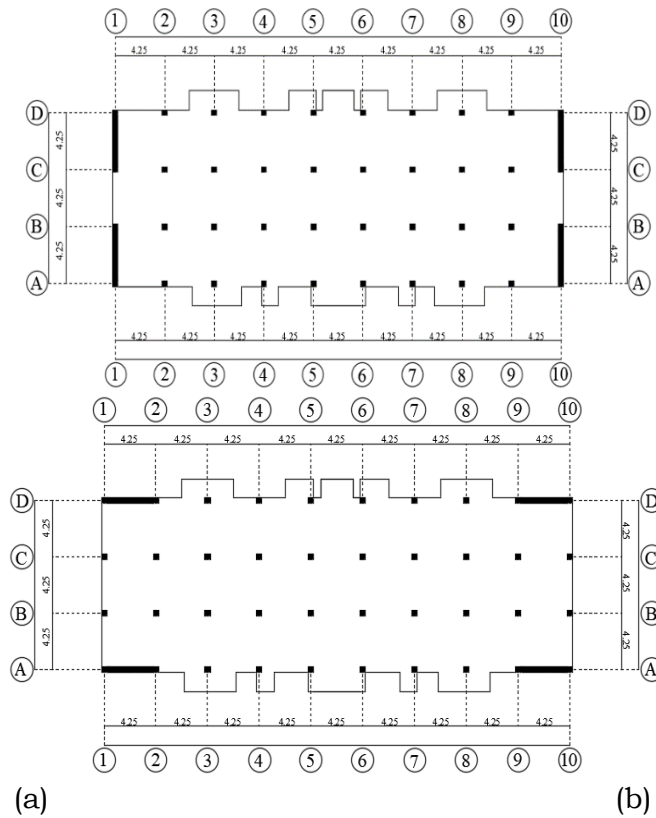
Denah lantai 1, lantai 2 dan lantai 3 gedung tinjauan
